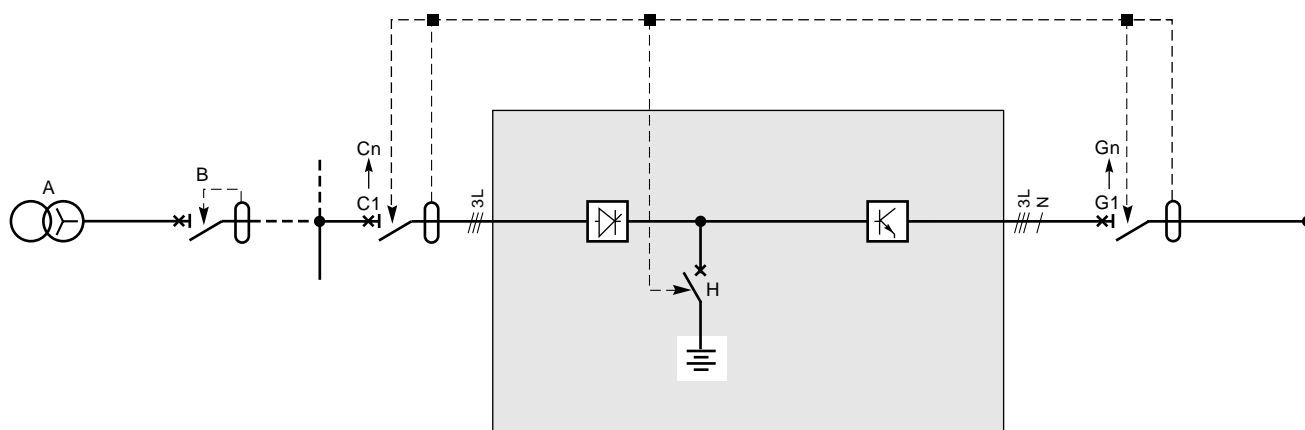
Dispositivos de protección para aislar una cadena de un SAI con batería de acumuladores no aislada de las instalaciones aguas arriba y aguas abajo según esquema TT.
